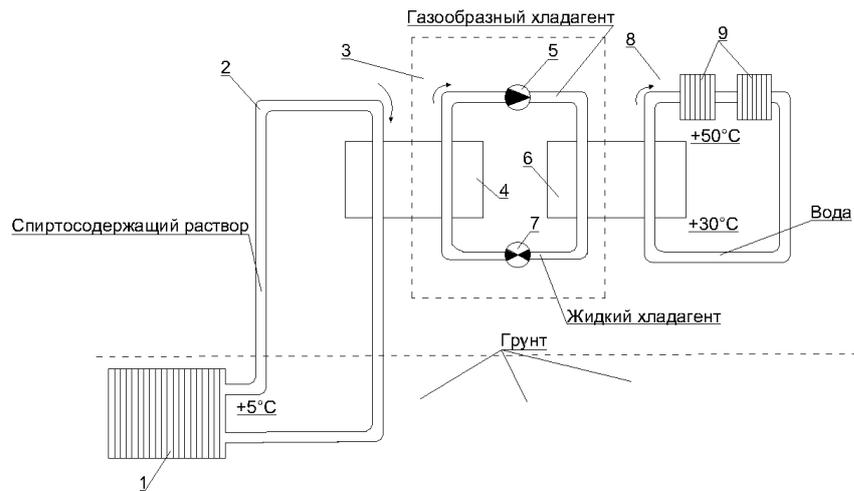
Функциональная схема теплонасосной отопительной системы, использующей тепловую энергию грунта
